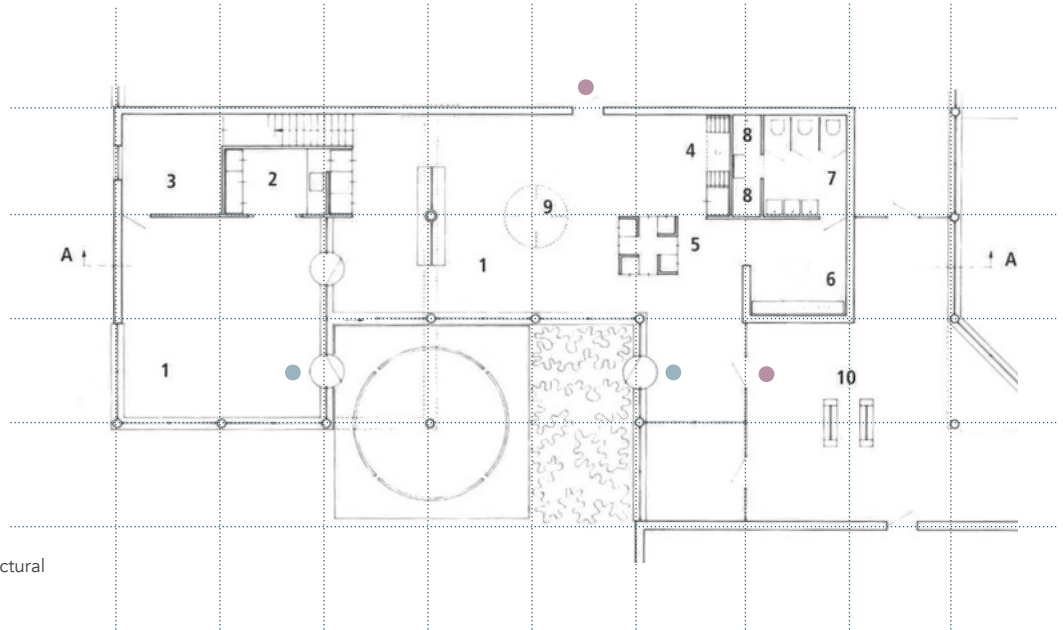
Planta baja, ejemplo de Tipología 1 (Departamento para niñas de 14-20 años)
